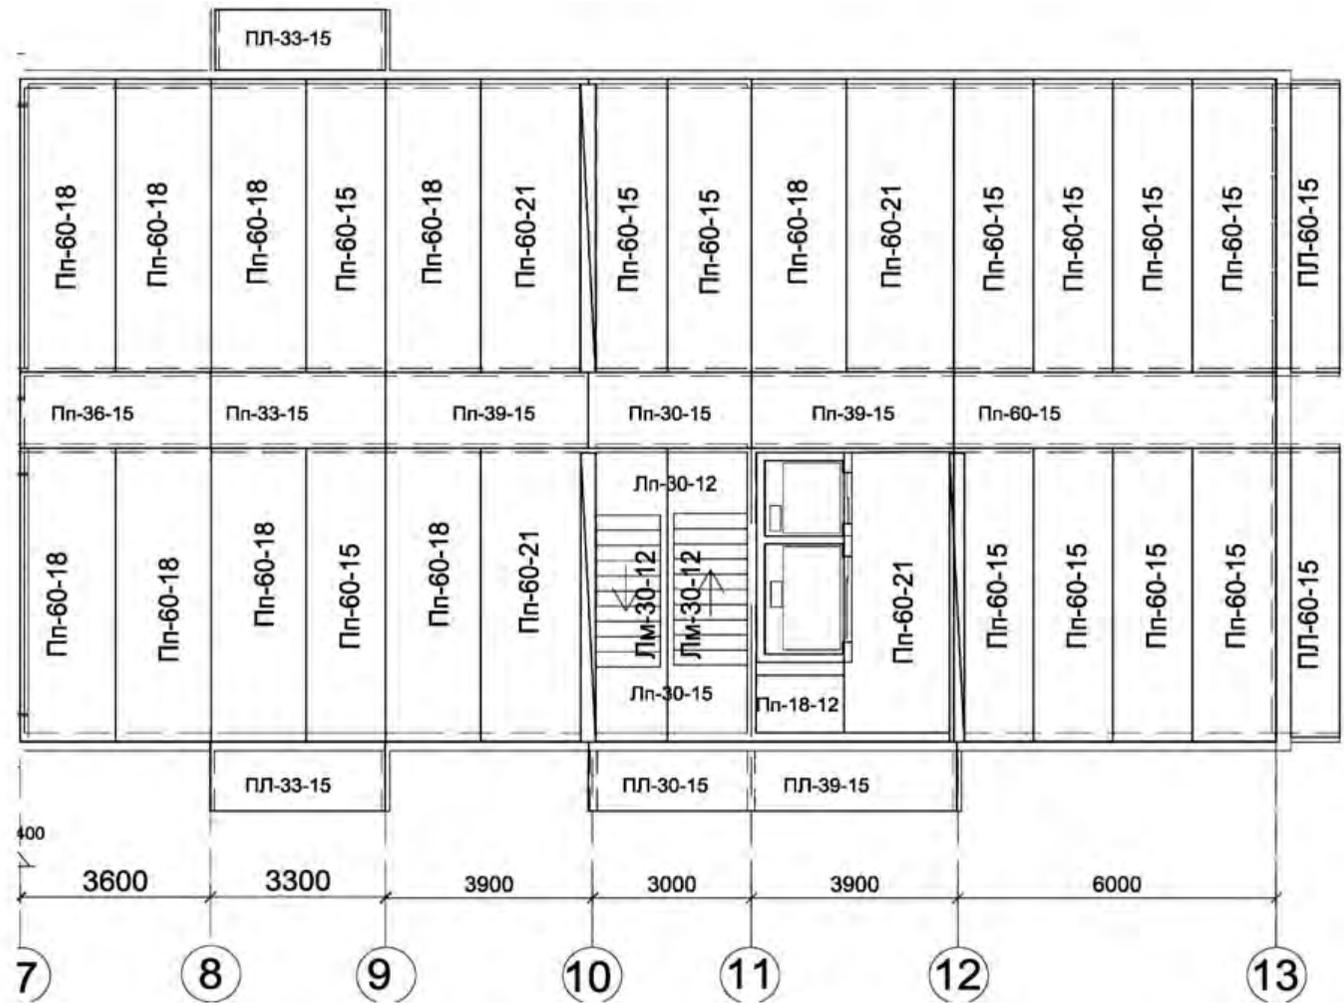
Фрагмент схемы перекрытия в здании с продольным расположением несущих стен
